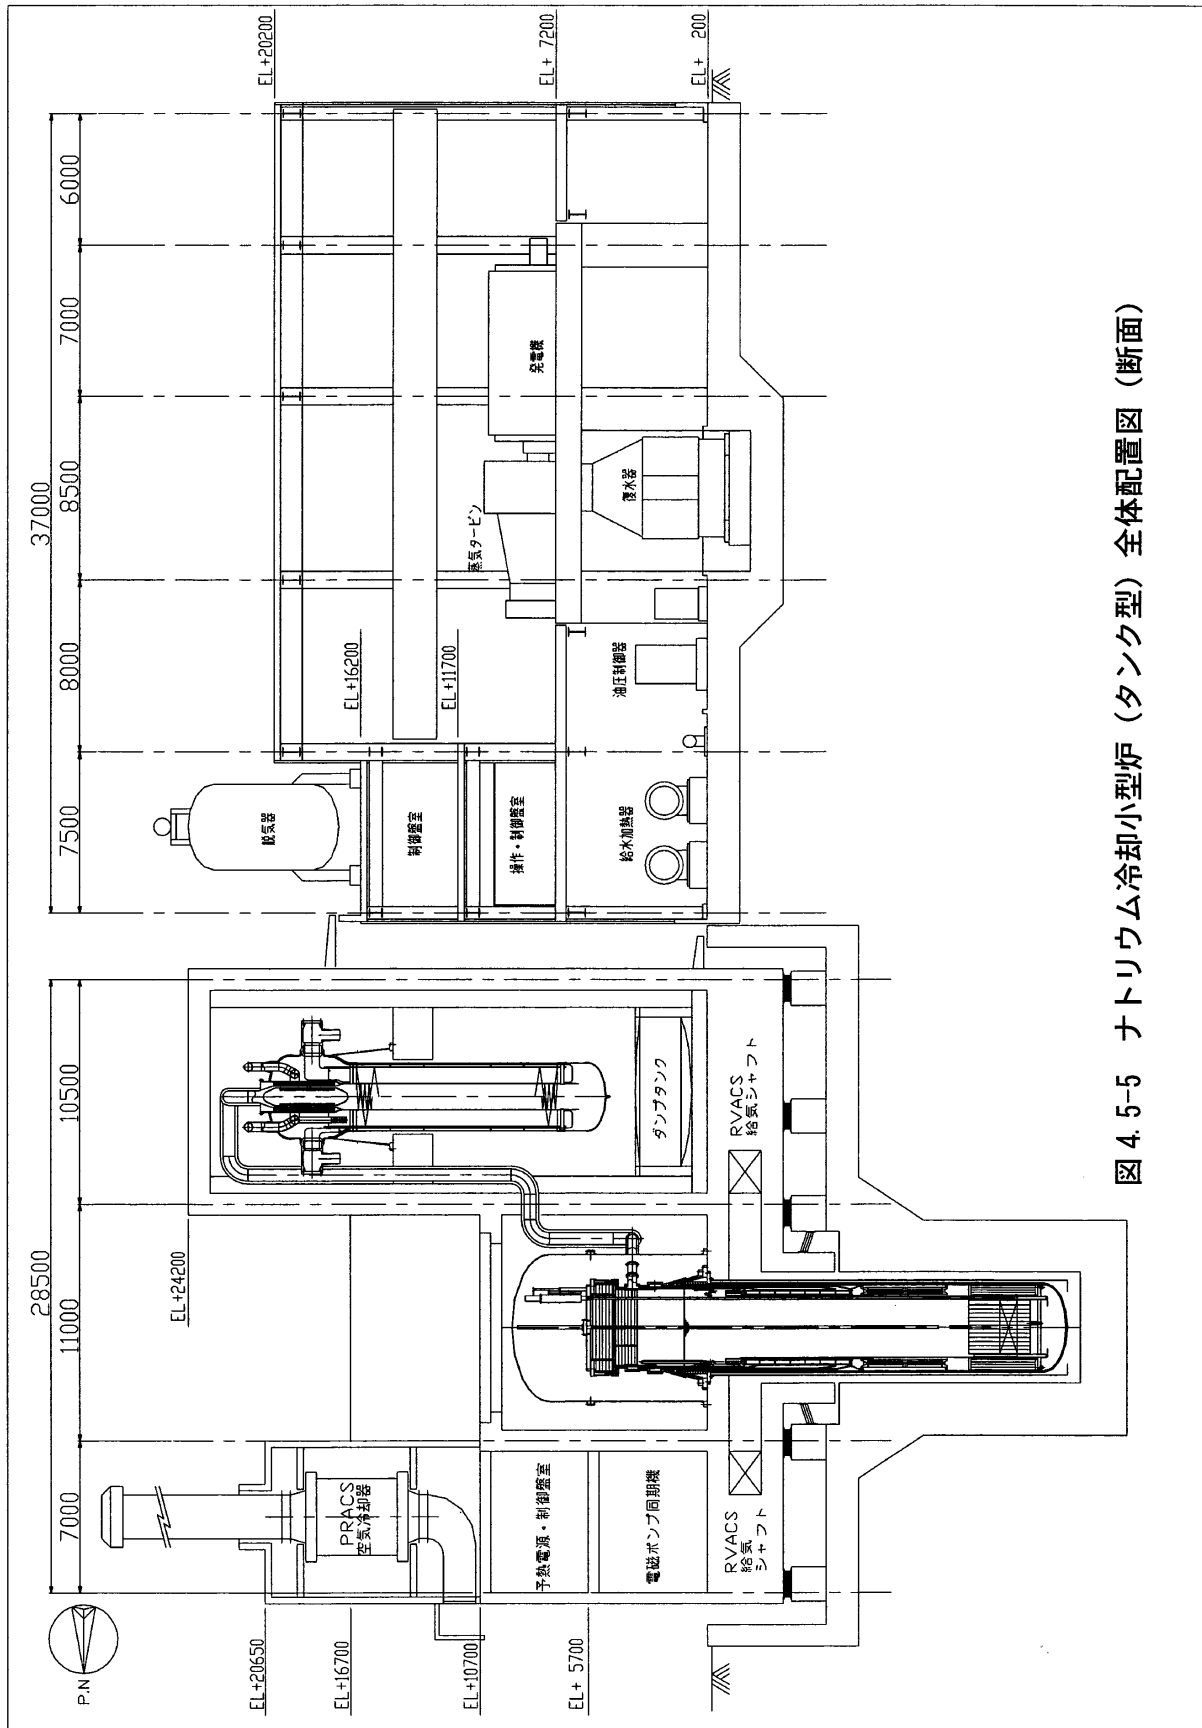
ナトリウム冷却小型炉 (タンク型) 全体配置図 (断面)
